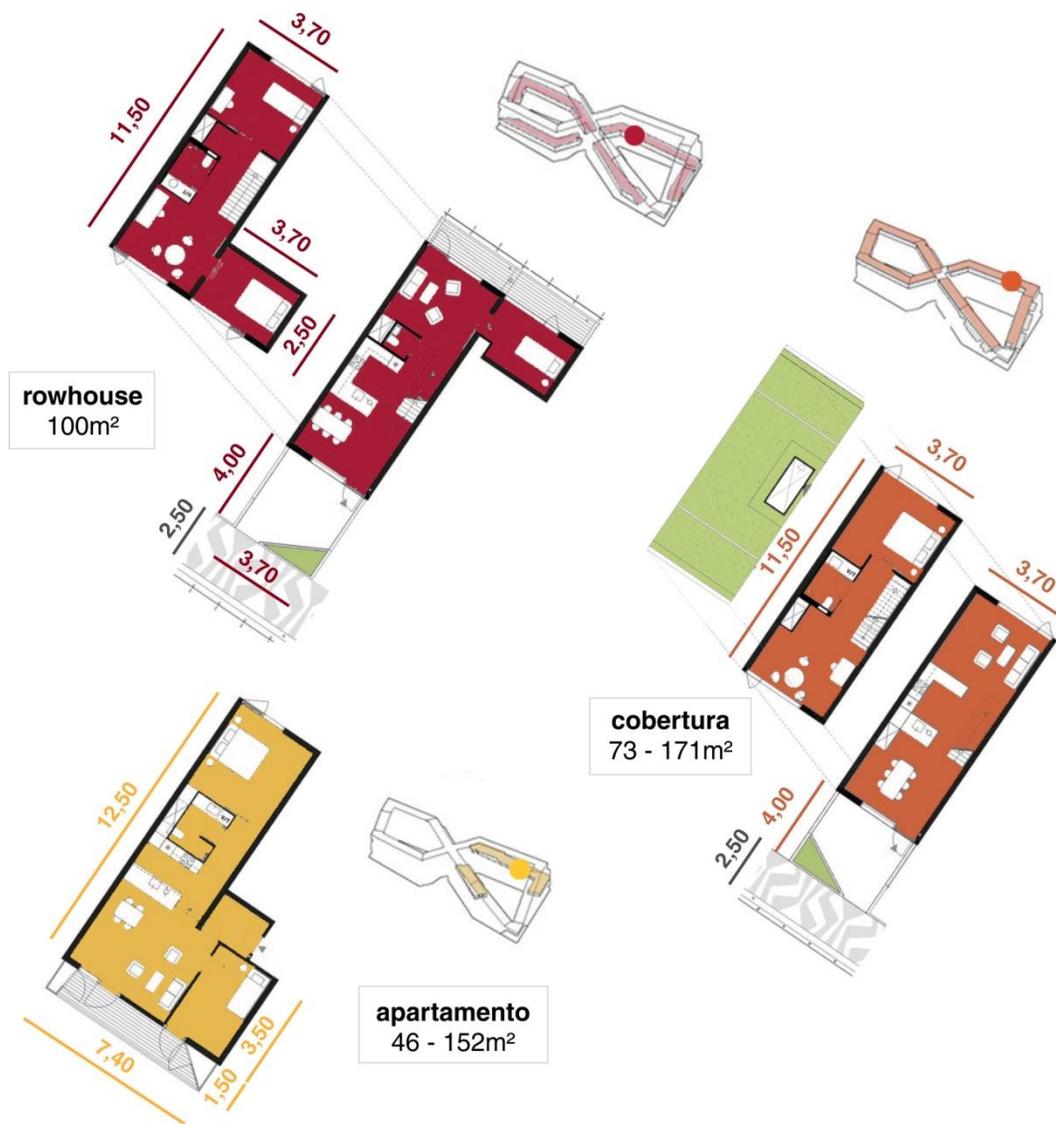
| 8 House - Diagrama plantas | BIG, 2010 (editado pela autora)
